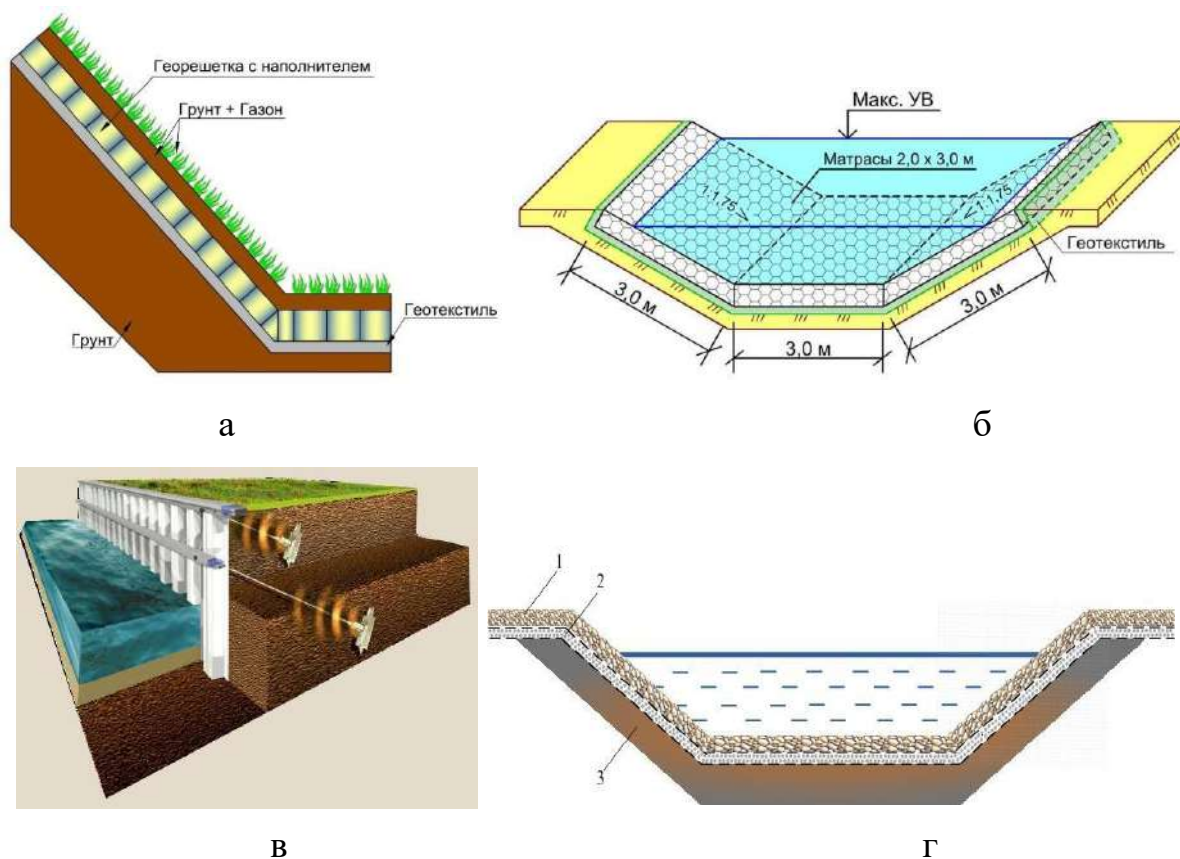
Варианты современного крепления канала: а – георешёткой с наполнителем; б – матрасами из габионов; в – шпунтиами из ВПХ; г – бентоматы или бетонное полотно Concrete Canvas: 1- каменная наброска; 2 – бентонитовые маты; 3 – грунт основания
